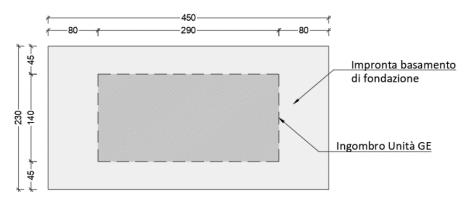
Schema dimensioni GE e platea di fondazione
